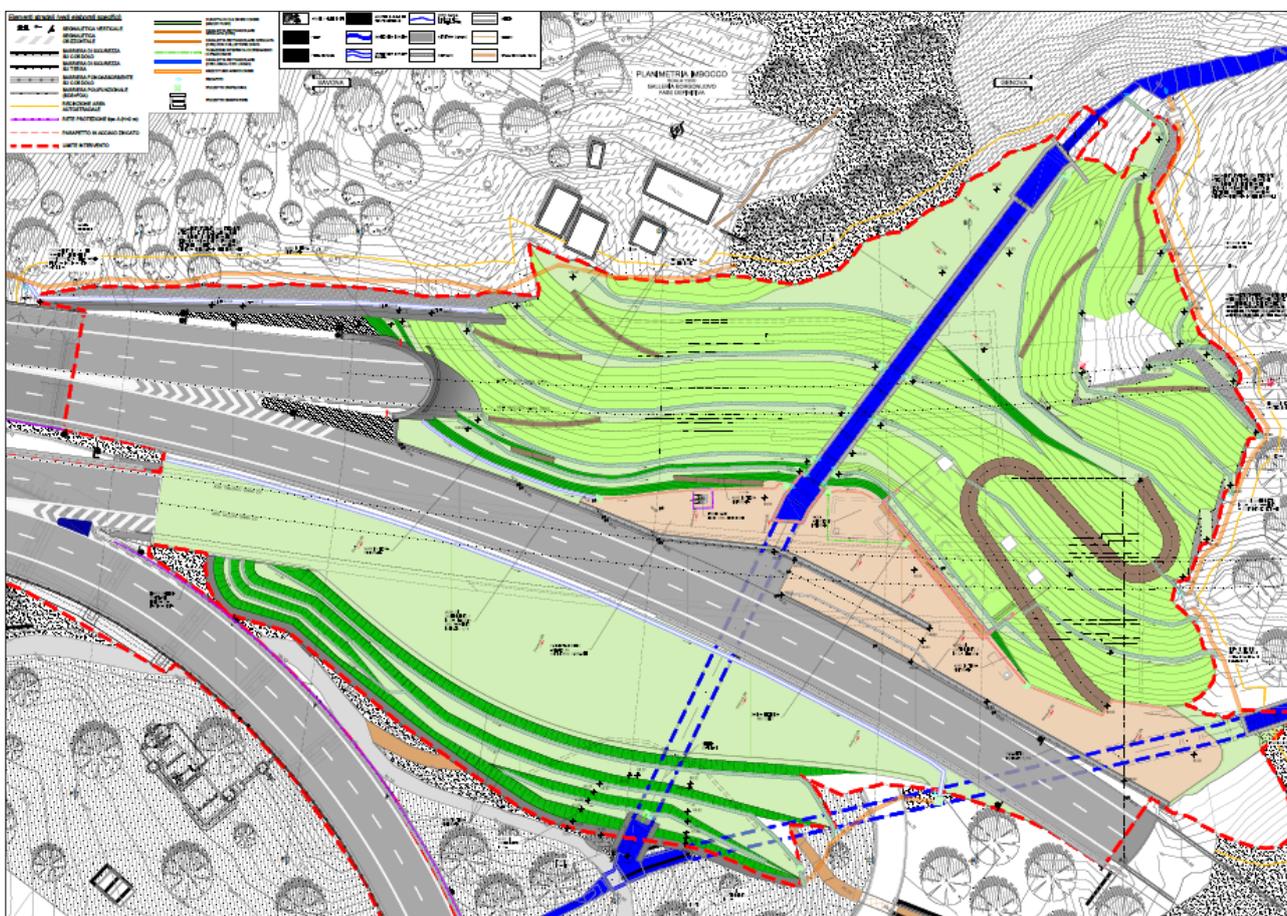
Planimetria sistemazione definitiva (fonte: elaborato 110728-LL8C-PE-A1-G01-GF01W-SSF00-D-AUA0540-1)
